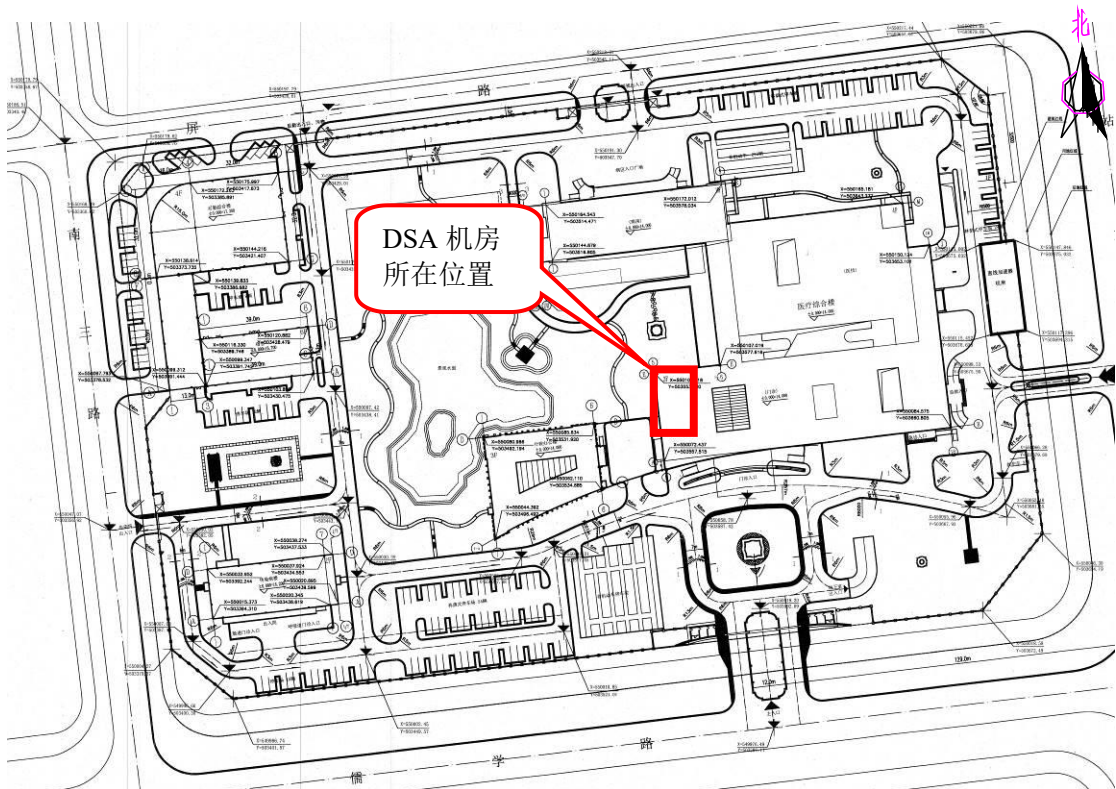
全椒县人民医院平面布置示意图及 DSA 机房所在位置
